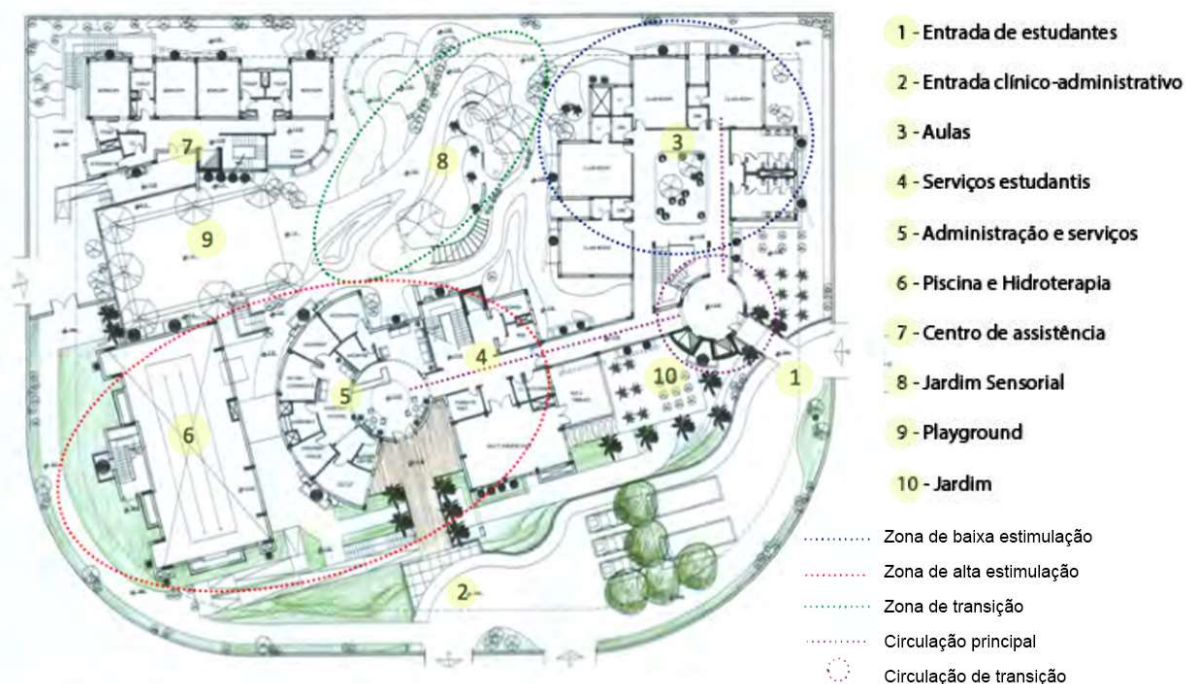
Planta baixa. Fonte: MOSTAFA, 2014.
